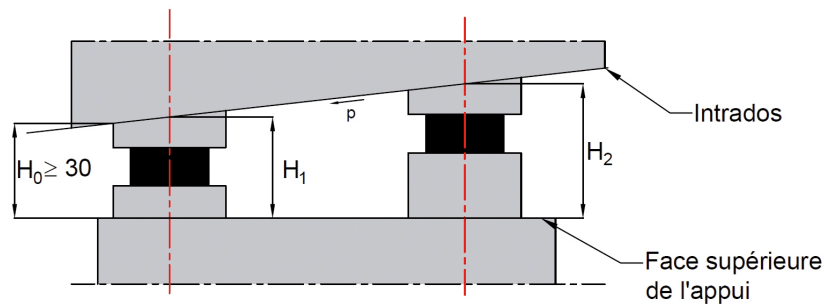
Hauteurs des bossages supérieur et inférieur
